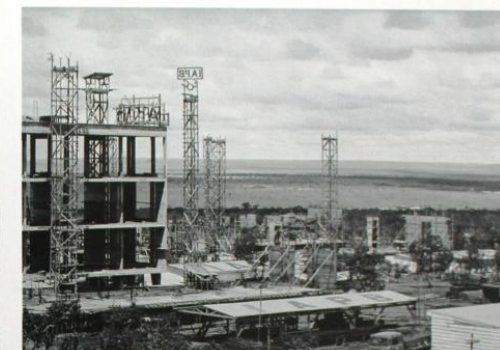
Foto da construção de bloco do IAPB que mostra a concretagem intercalada das lajes dos pavimentos e as torres de madeira utilizadas no canteiro. Fonte: Arquivo Público do DF.
